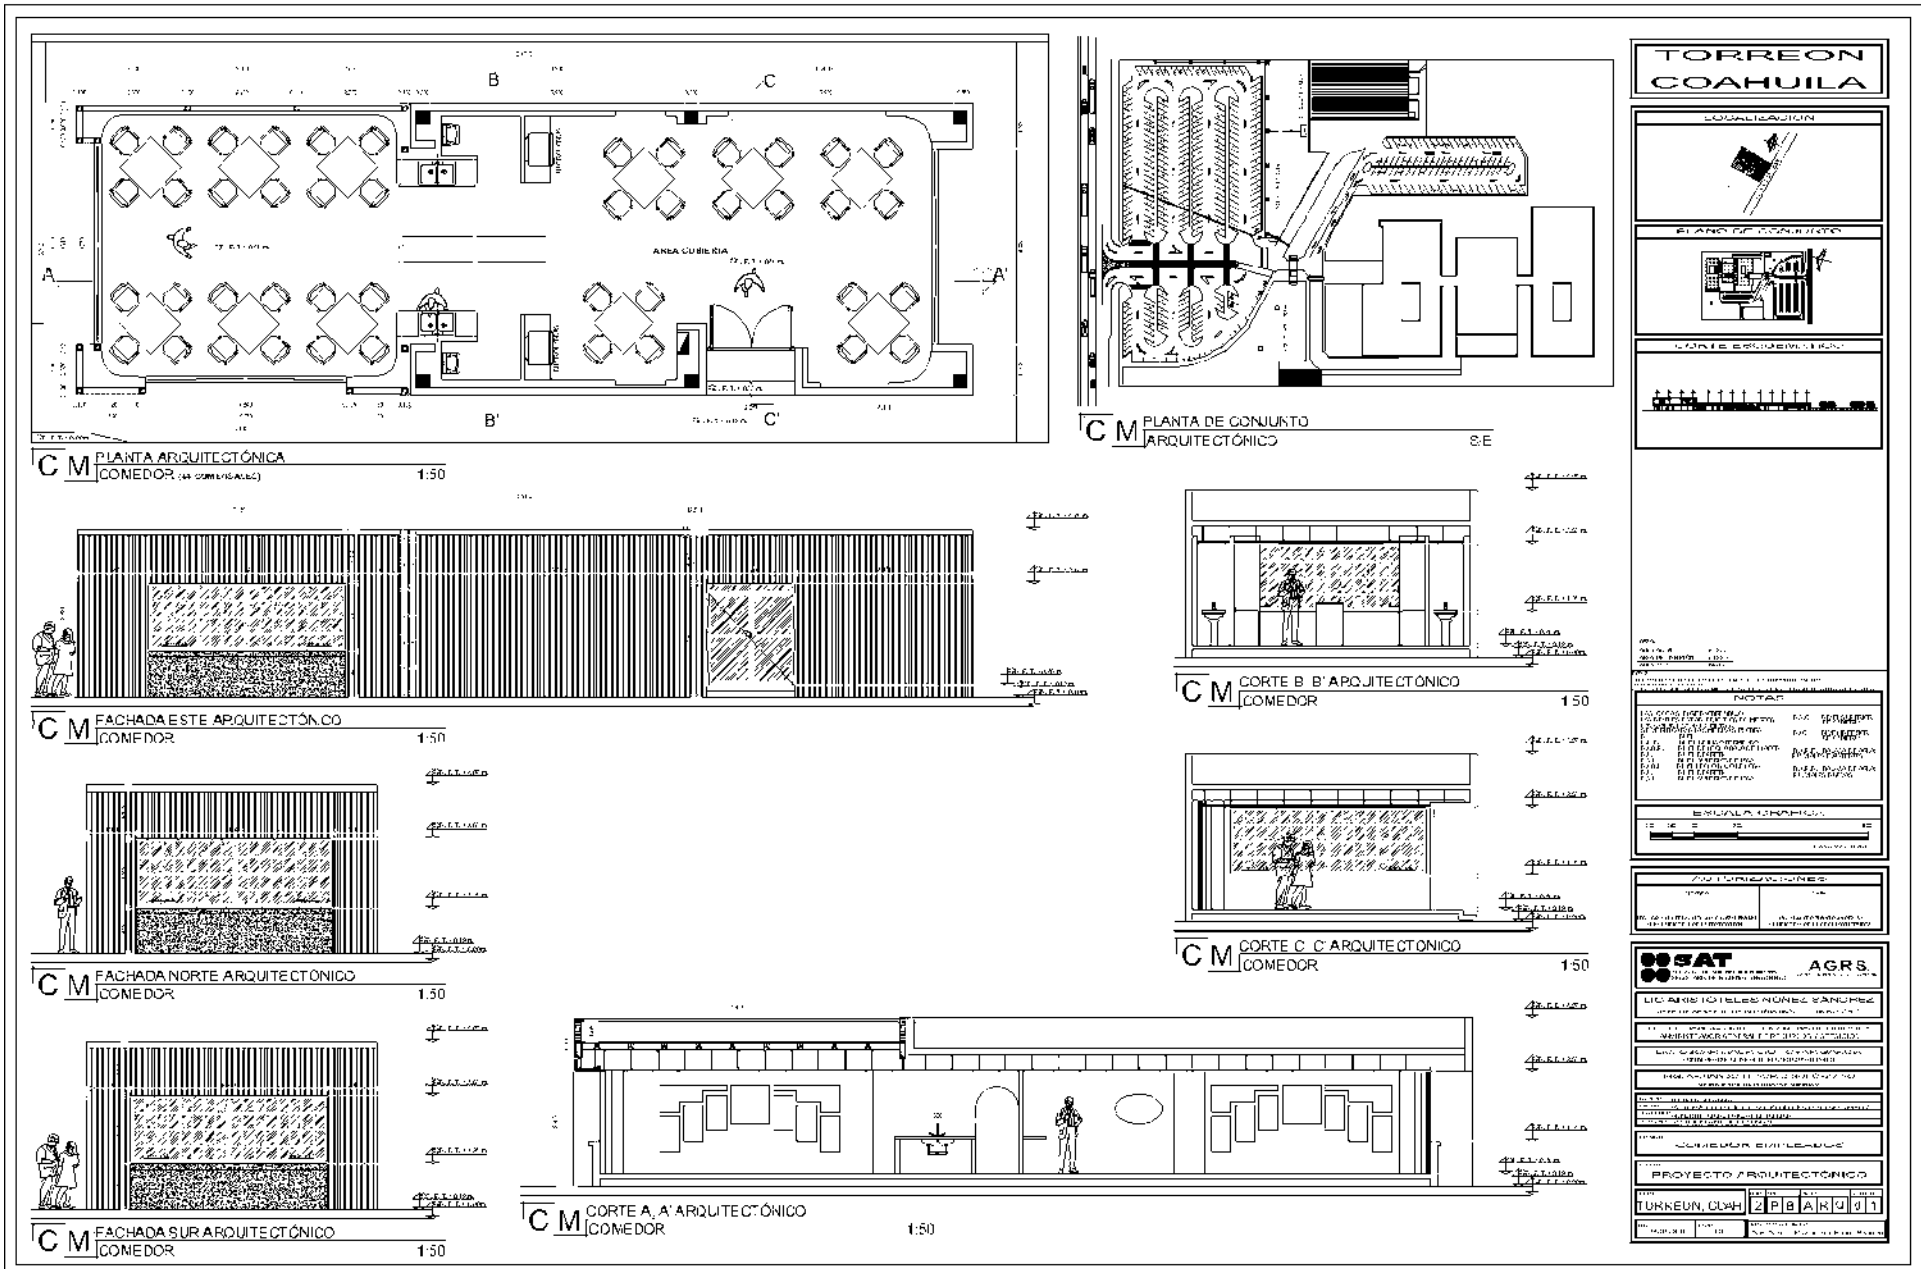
C-PA-ARQ-01 Planta 1er N. edificio C
